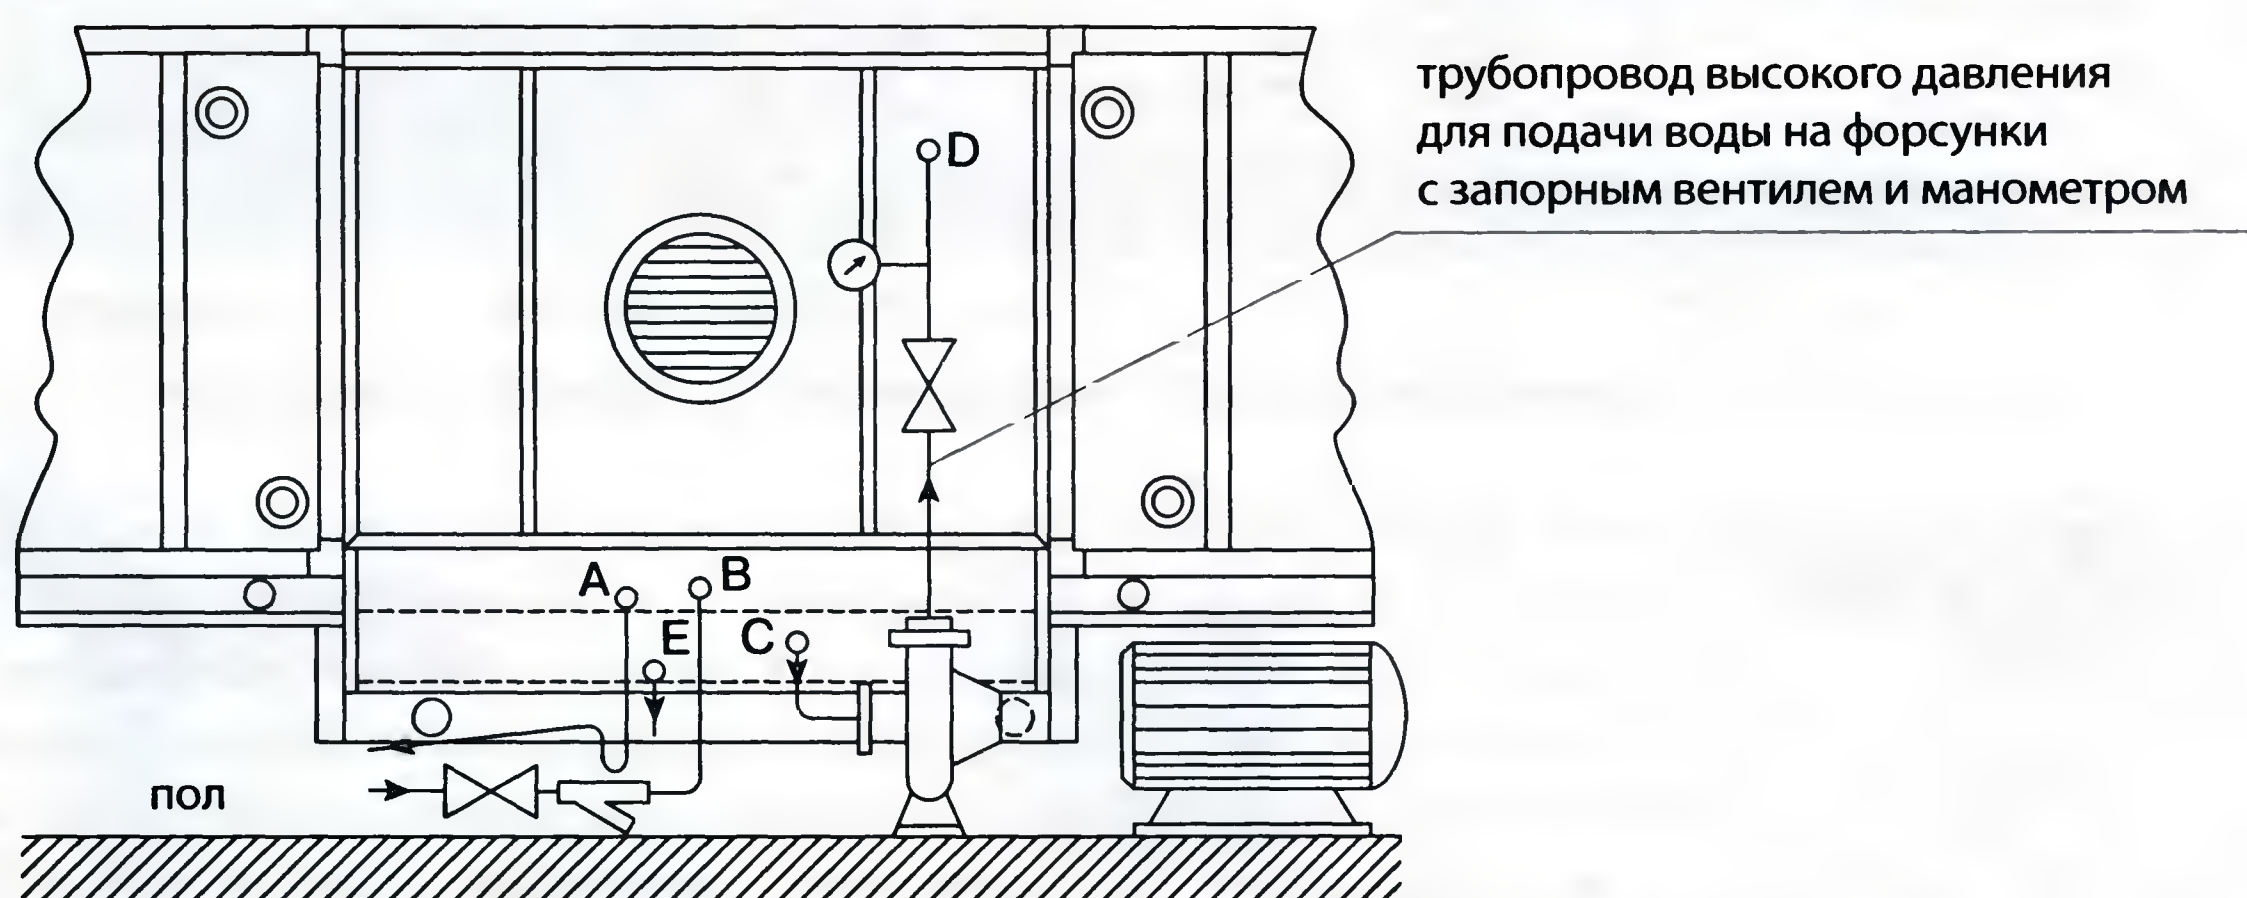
Установка и подсоединение форсуночной камеры орошения:
